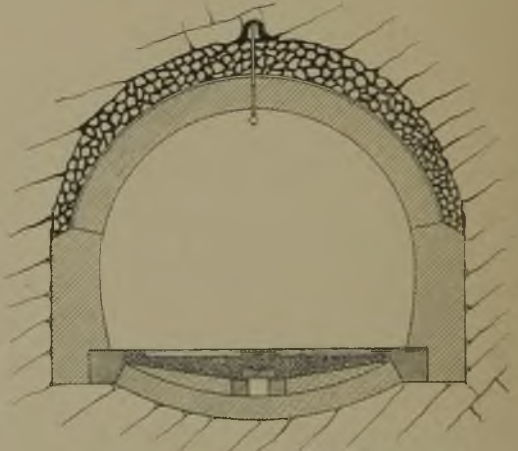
Tunnel in Mauerwerk mit Rückenbetonierung.
